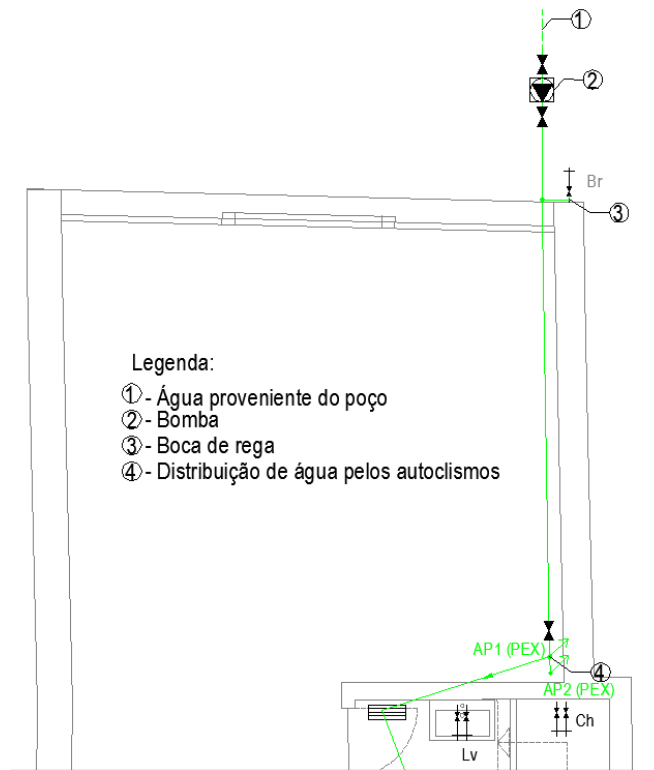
Sistema de aproveitamento de águas do poço – planta de rés-do-chão
